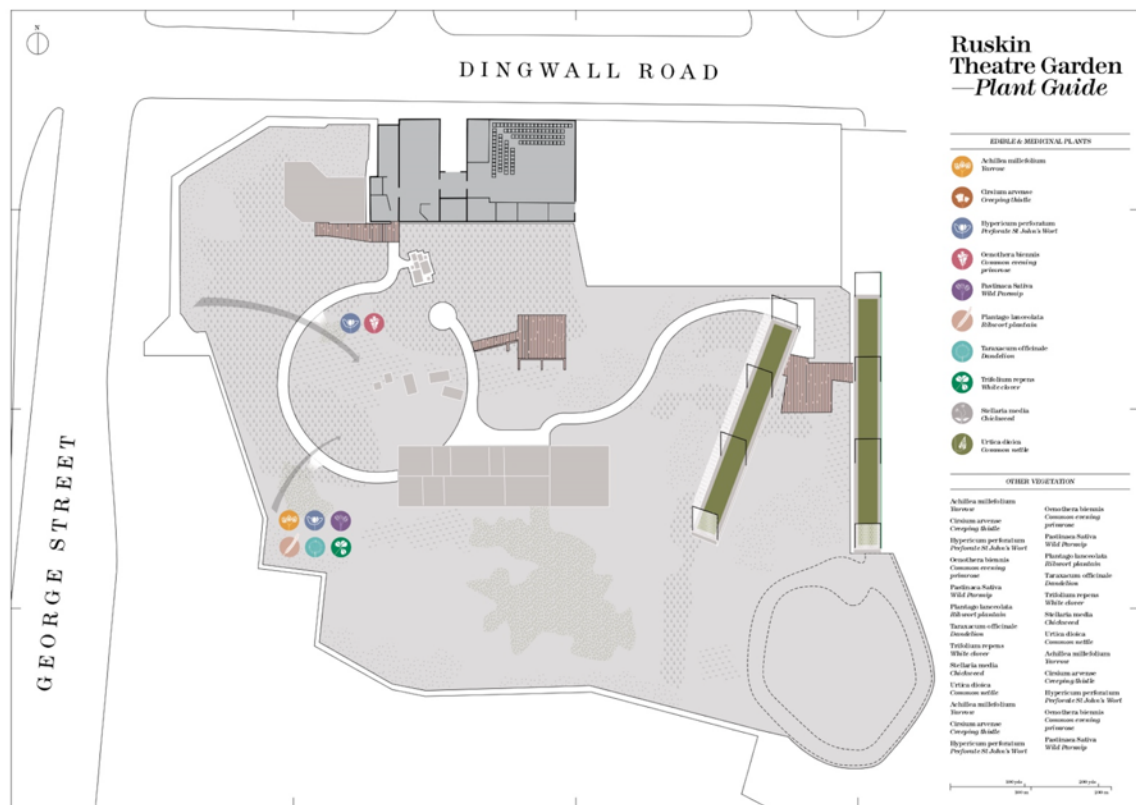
Planta da intervenção “Ruskin Theatre Garden”. Imagem: arquivo muf architecture/art.
